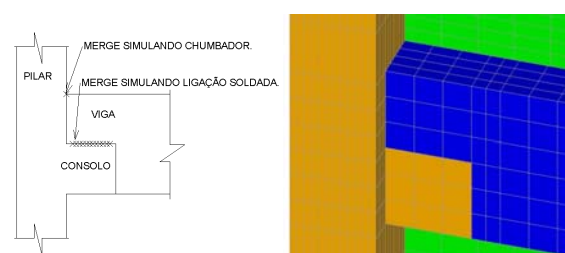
Detalhe da ligação viga-pilar (consolo).
